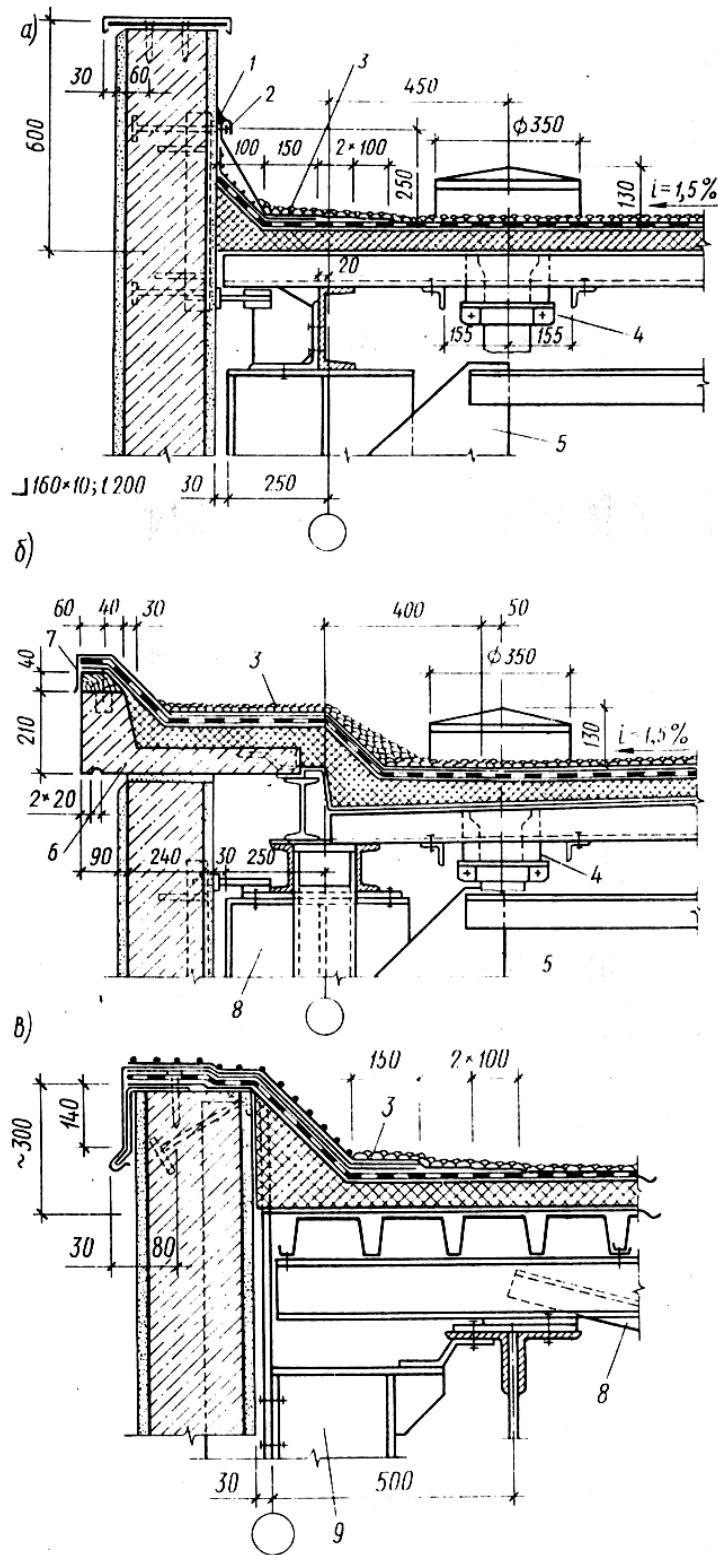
Примыкание легкого покрытия к наружным стенам:
